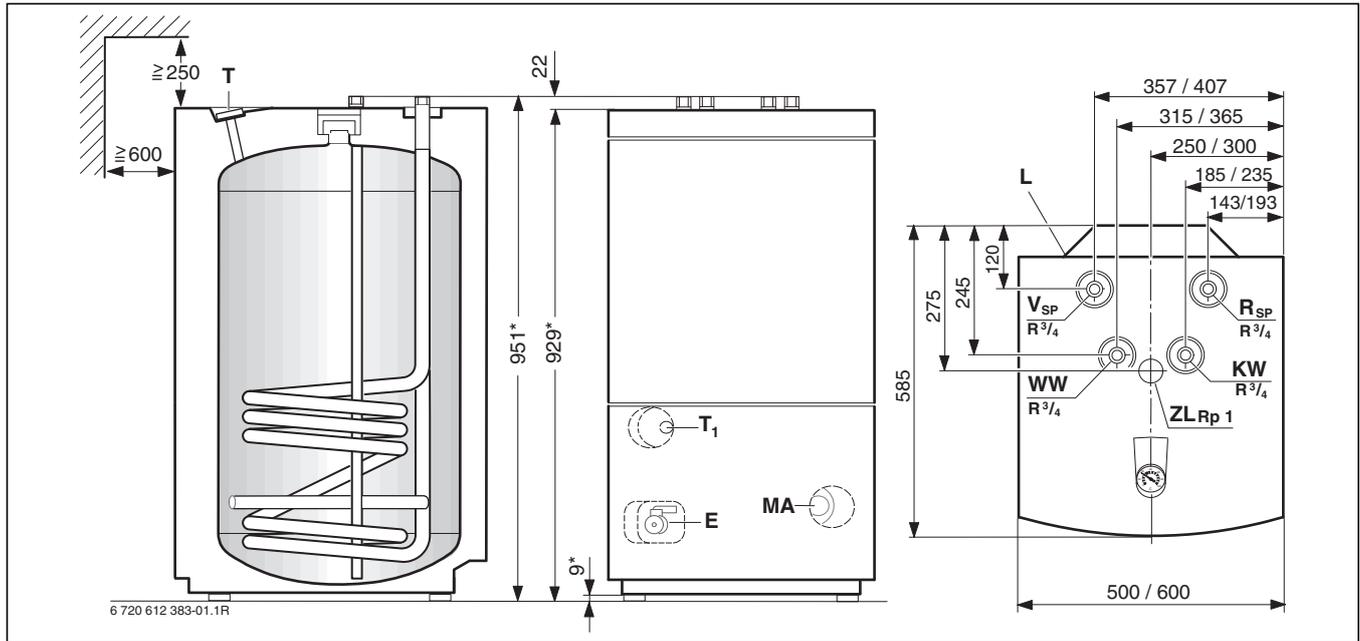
Bau- und Anschlussmaße ST 120-2 E. und ST 160-2 E. (Maßangaben hinter einem Schrägstrich beziehen sich auf die größere Speicherausführung)
